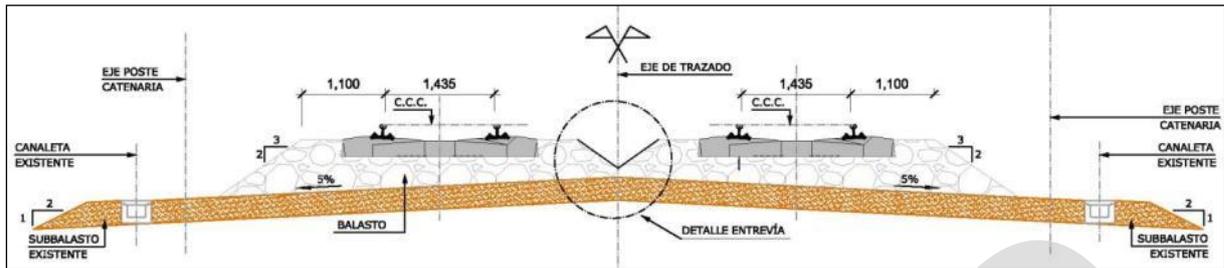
Esquema de perfilado de la sección tipo de entrevía en recta.
